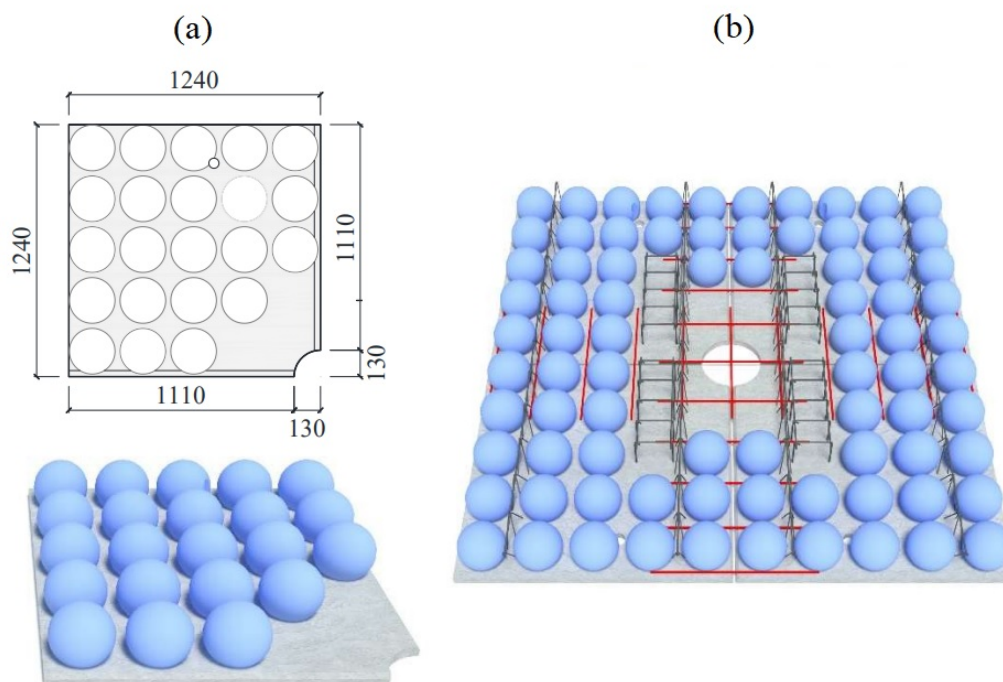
Pré laje: dimensões (a) e barras de ligação (b) (dimensões em mm) (fonte: Nicácio (2018))
